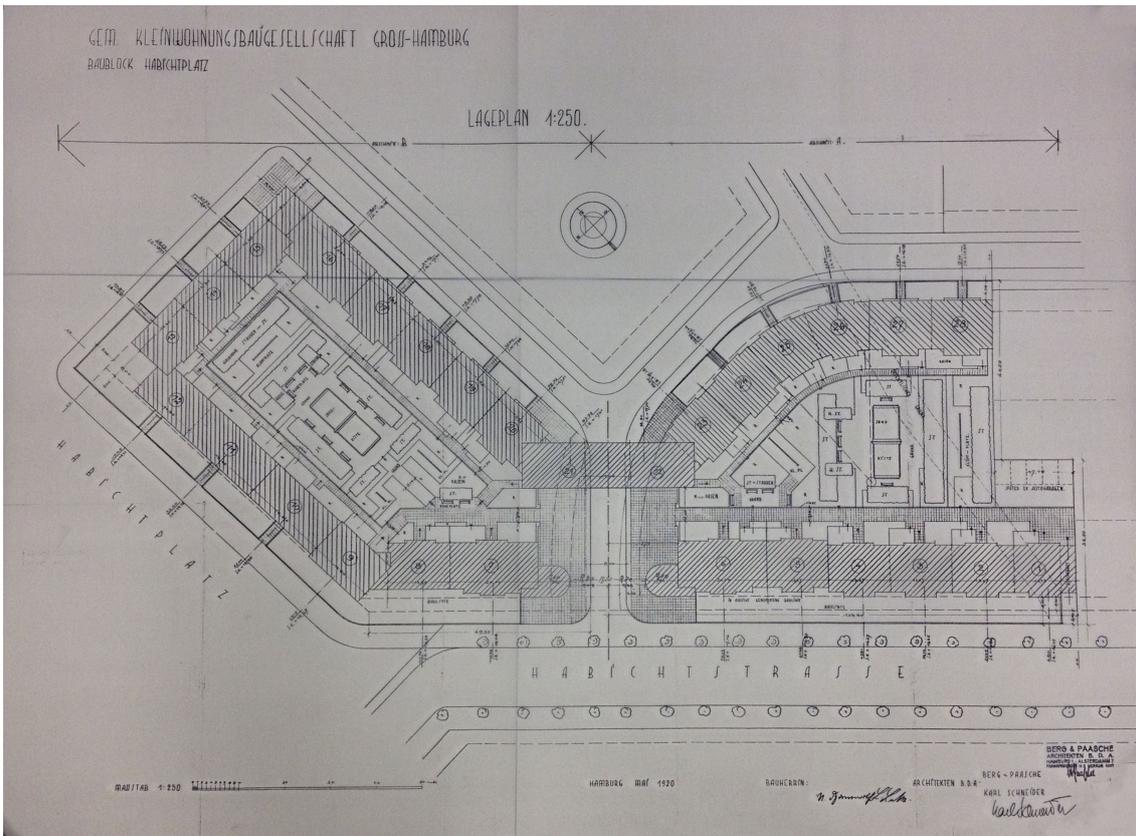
Lageplan zum Bauantrag, Mai 1927
